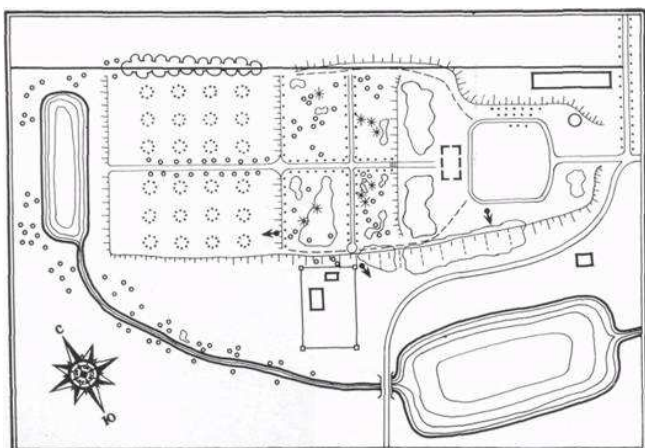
Схема-генплан усадьбы «Дубой»
